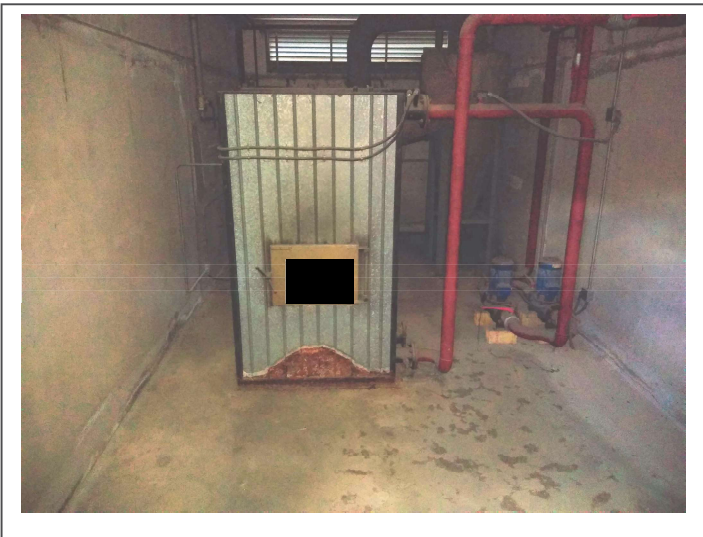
Locale C.T. con caldaia inutilizzabile
